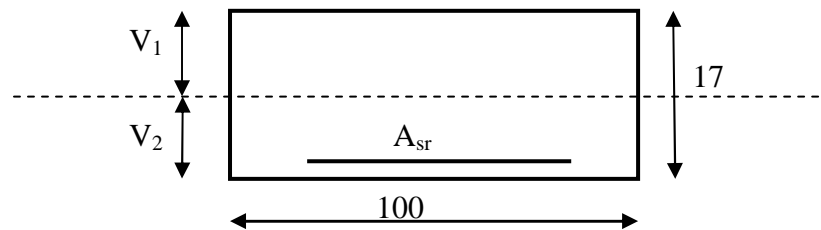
Coupe longitudinal dans la paillasse
